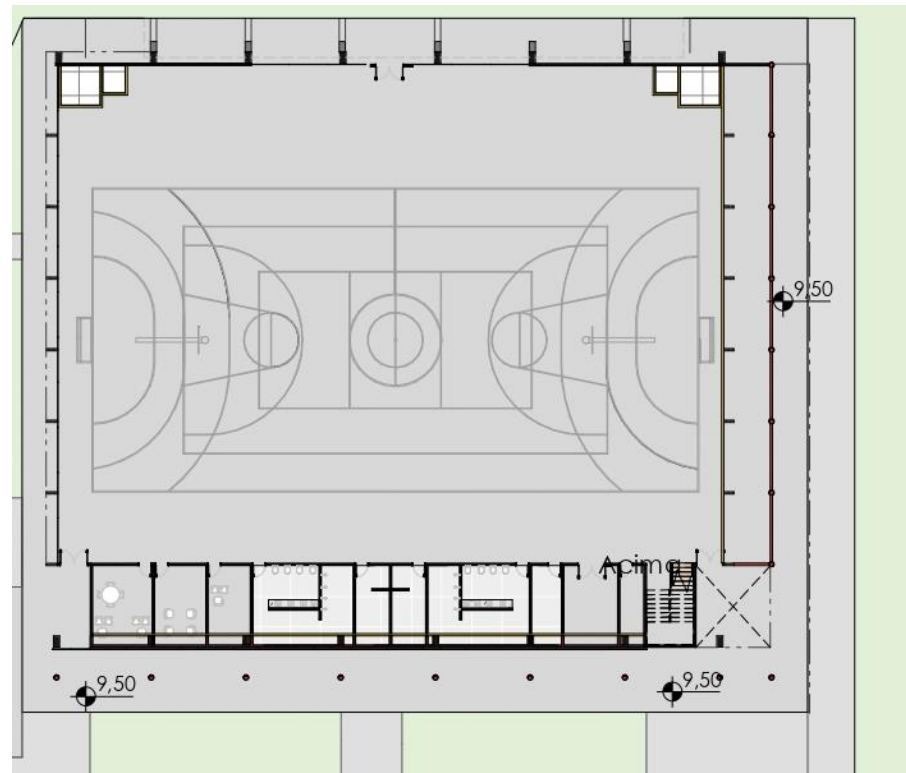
Planta de demolição e construção do ginásio (Escala 1/500) | Fonte: Produzido pela autora
